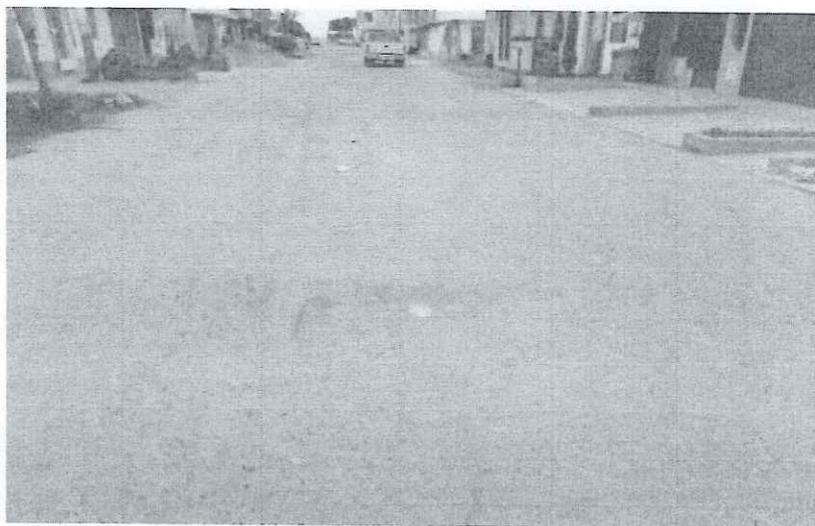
SE APRECIA GRIETAS Y FISURAS EN EL AV. G MANUEL AREVALO II ETAPA - AV. INDOAMERICA
